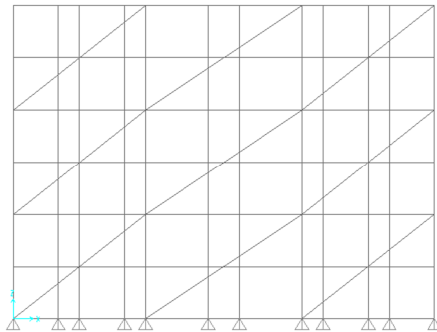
Configuração dos Planos de Contraventamento Vertical Com Elementos de Contraventamento Grandes
